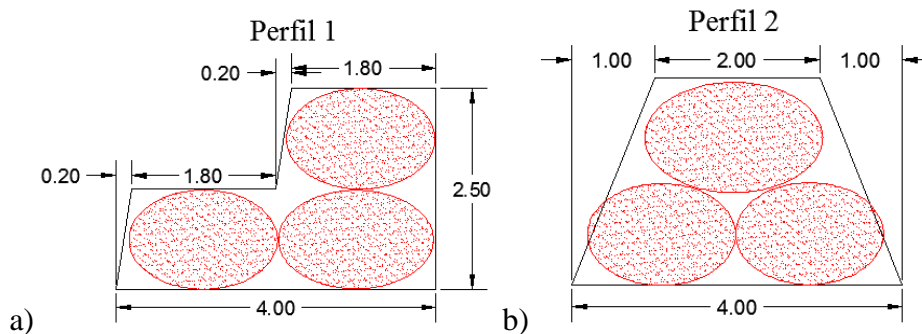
Ilustração da disposição dos sacos de geotêxtil a) perfil 1; b) perfil 2.
